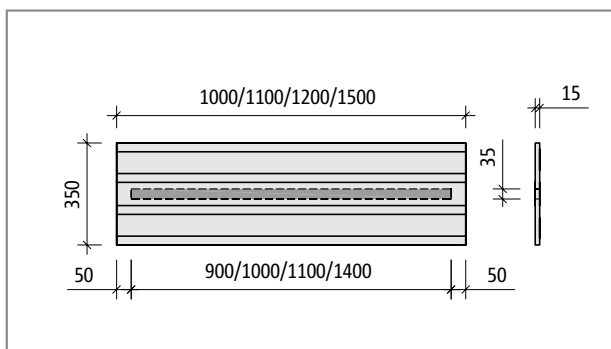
Schöck Tronsole® tipo B-V2-L...-B350, pianta del prodotto
